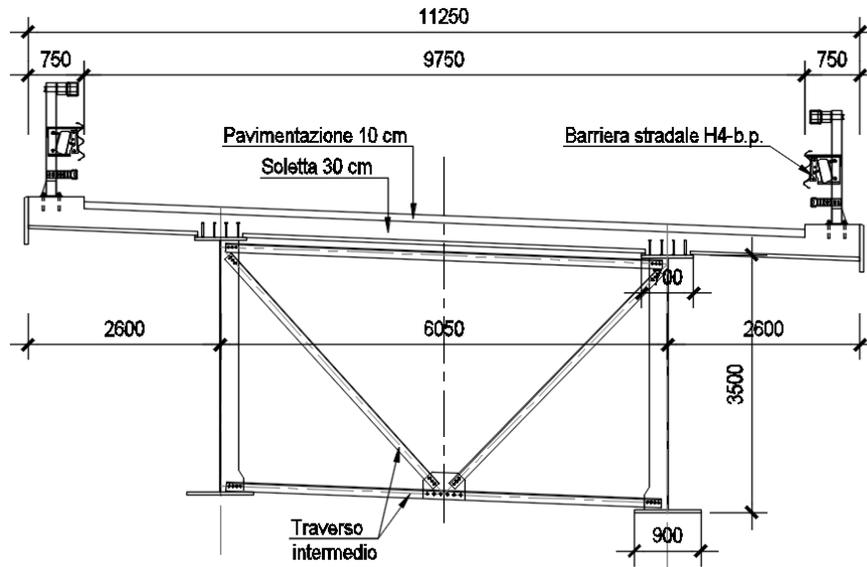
Viadotto Eremita – Sezione corrente impalcato
